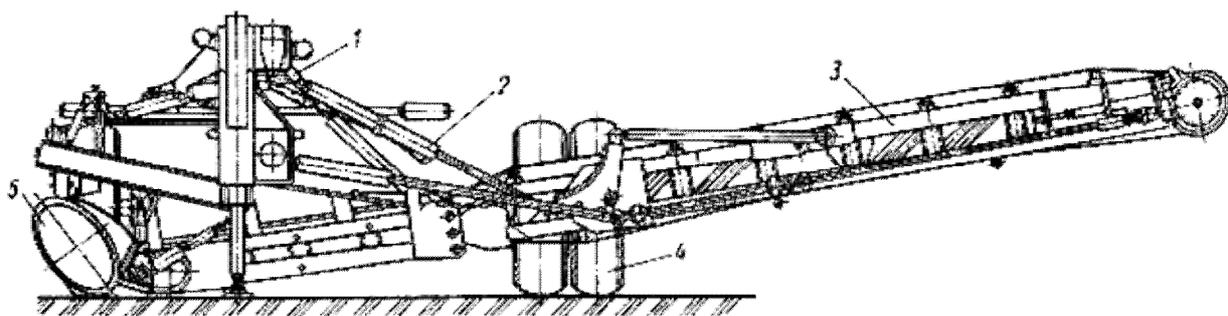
Грейдер-элеватор: 1 – рама; 2 – гидродвигатели управления транспортером; 3 – транспортер; 4 – пневмоколесный ход; 5 – диск или совок
